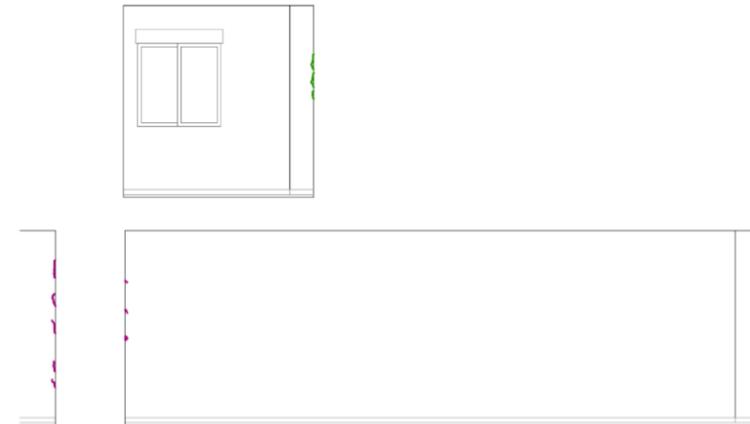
Fisuras grandes/ grietas vivienda 5 planta segunda. 2018. Elaboración propia
